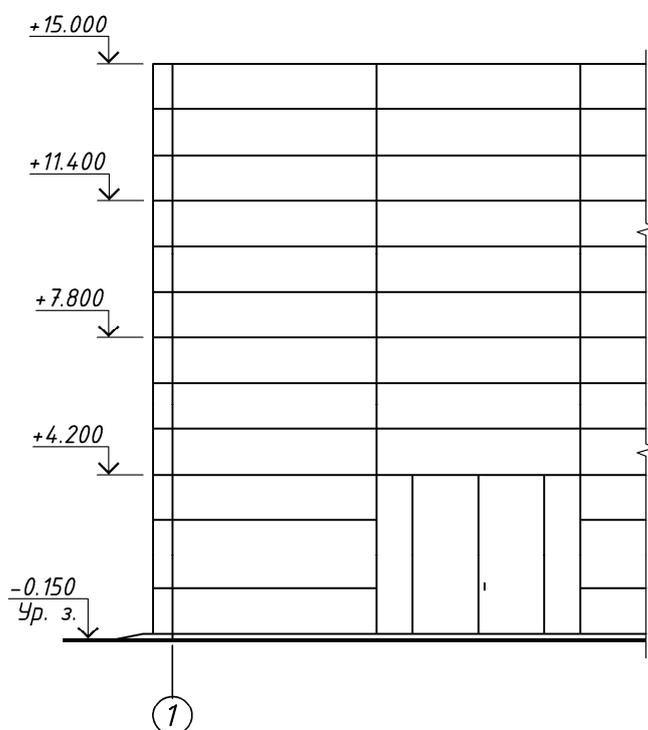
Нанесение высотных отметок уровня на фасадах и разрезах
